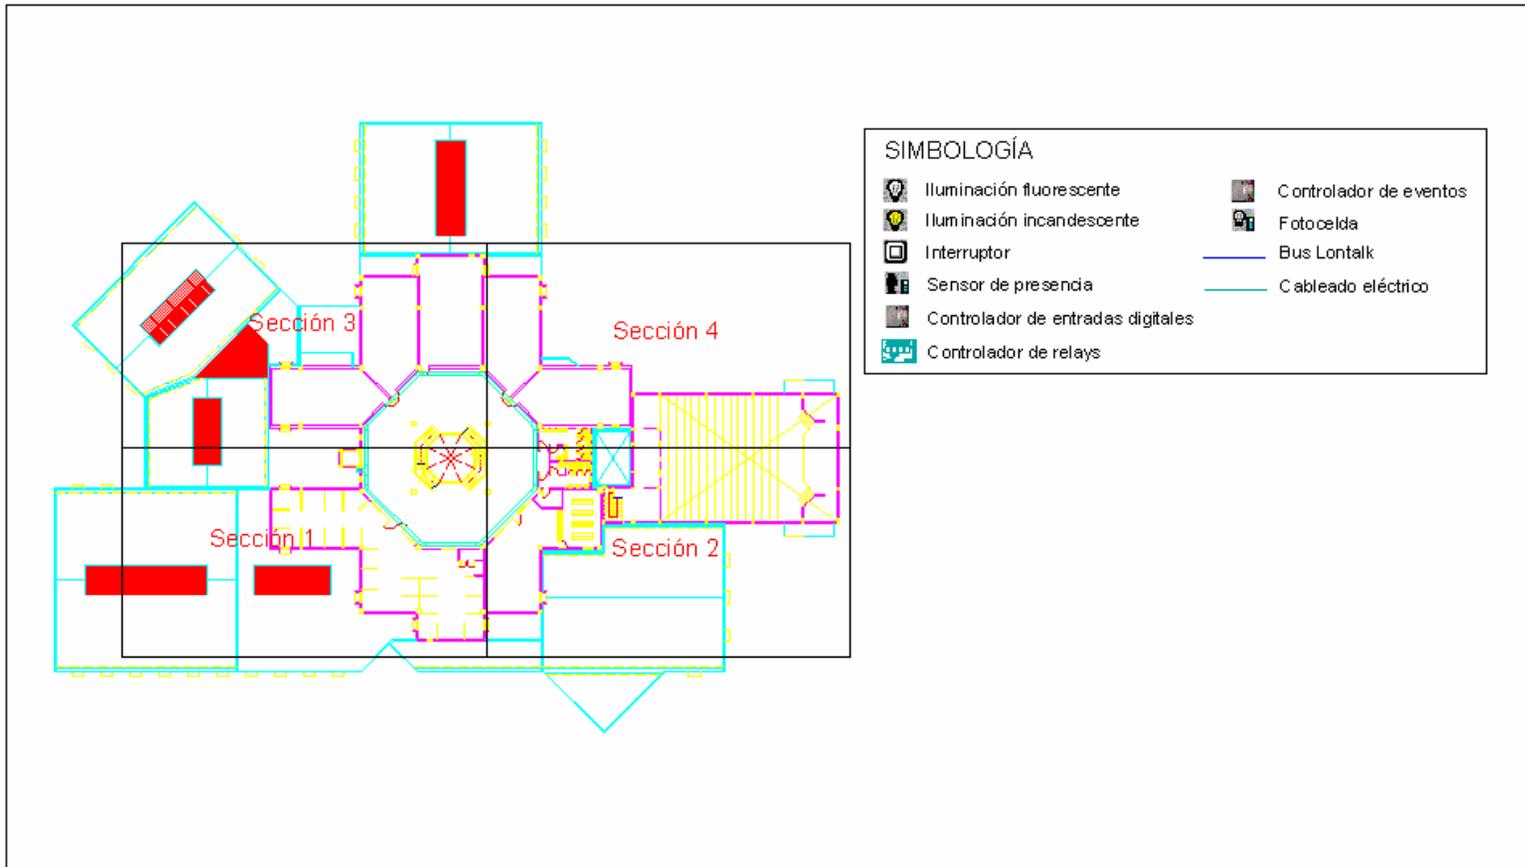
PLANO ILUMINACIÓN PRIMER PISO GENERAL
